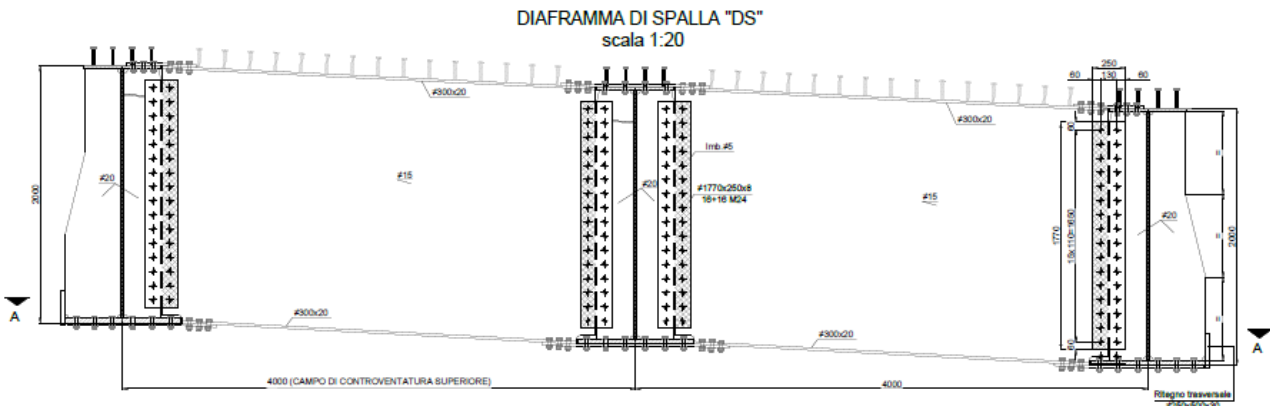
Sezione trasversale su diaframmi di spalla
